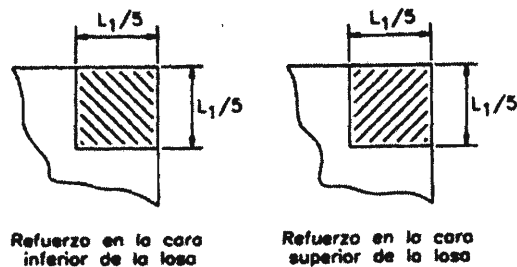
Refuerzo adicional en las esquinas de las losas
